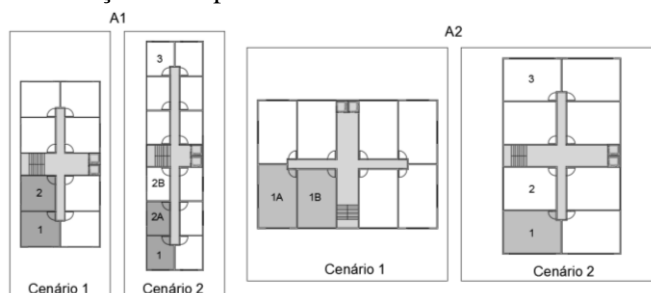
Planta baixa dos cenários 1 e 2, da A1 e A2.
